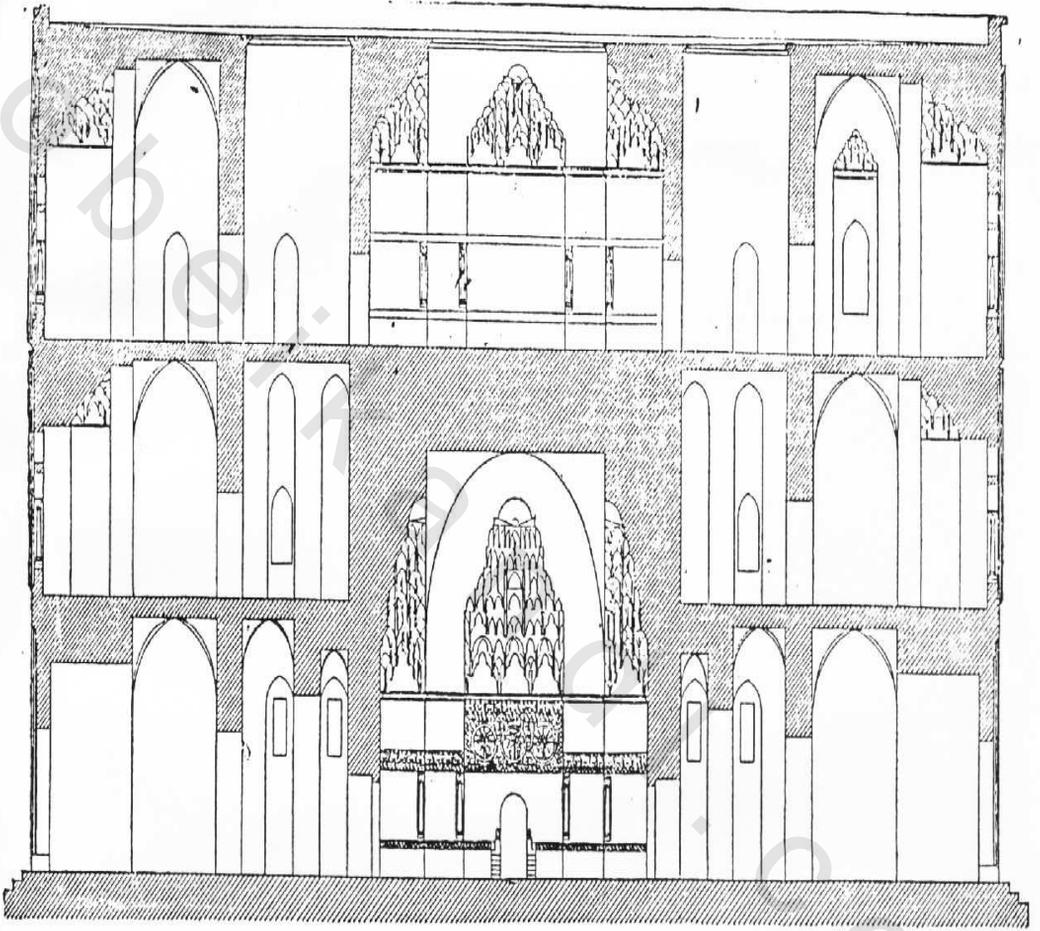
مسقط أمقي لقصر العزيزة ببالرمو (١١٦٥ - ١١٨٠م) من :
